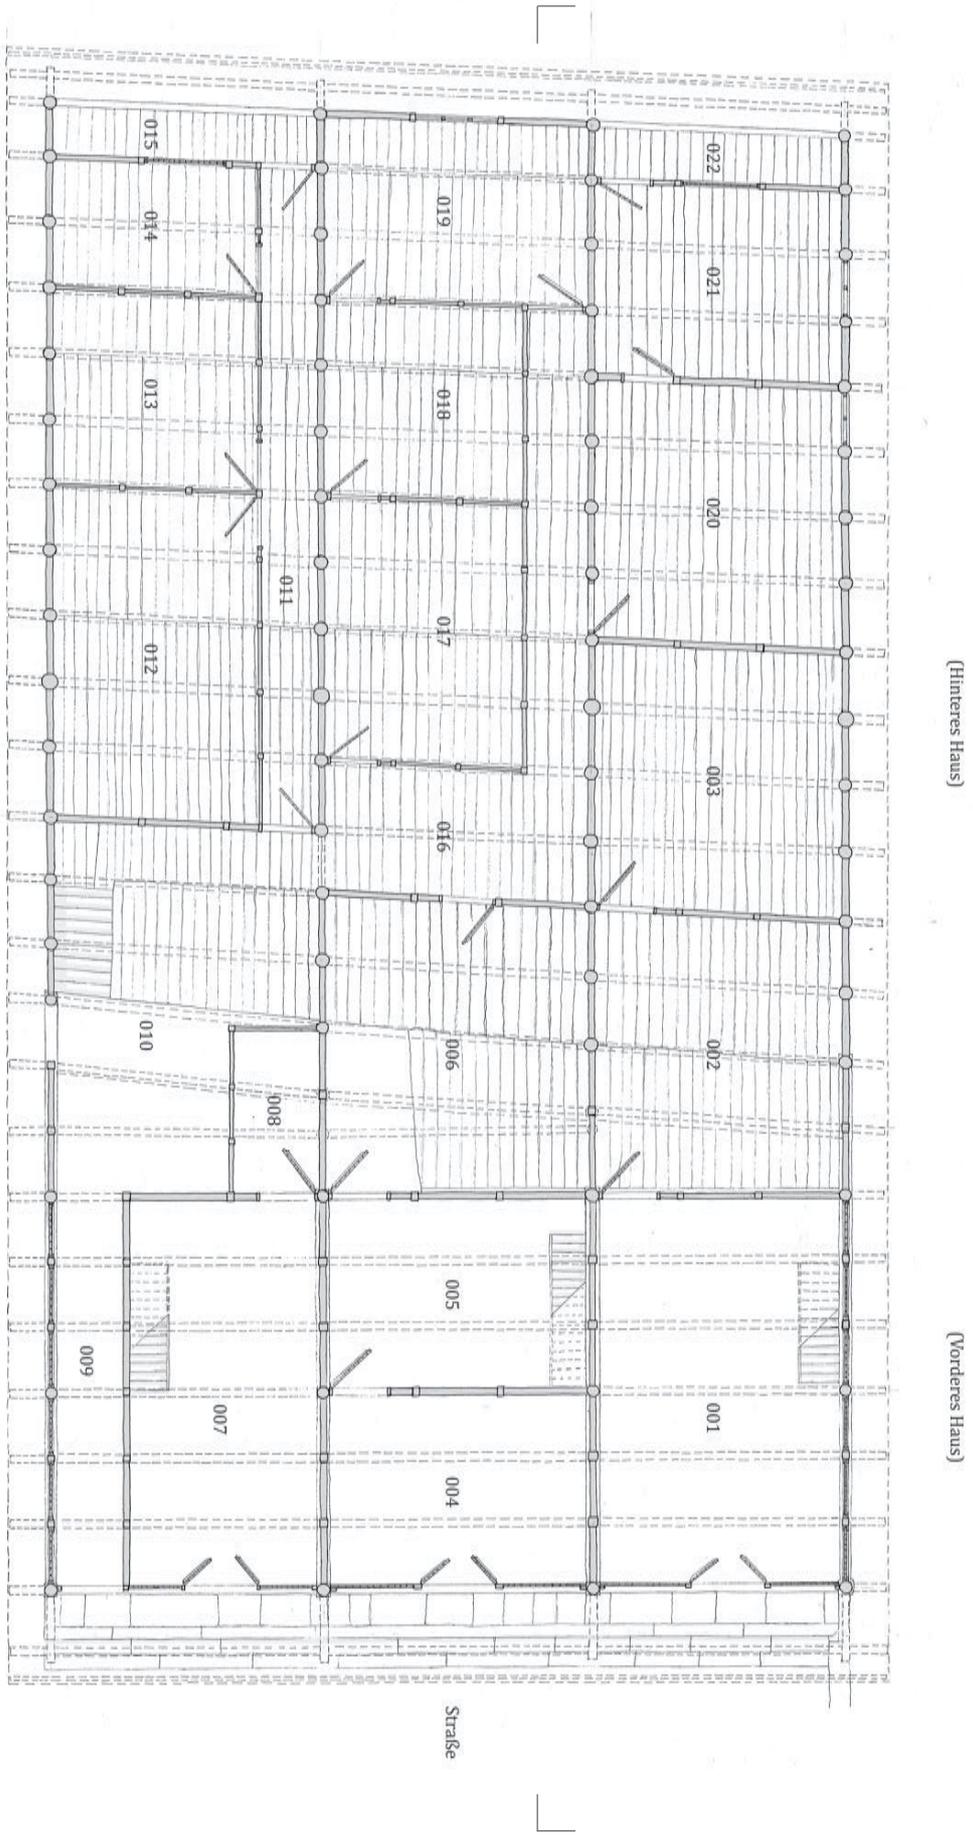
Grundriss Haus He (EG), M 1:125
